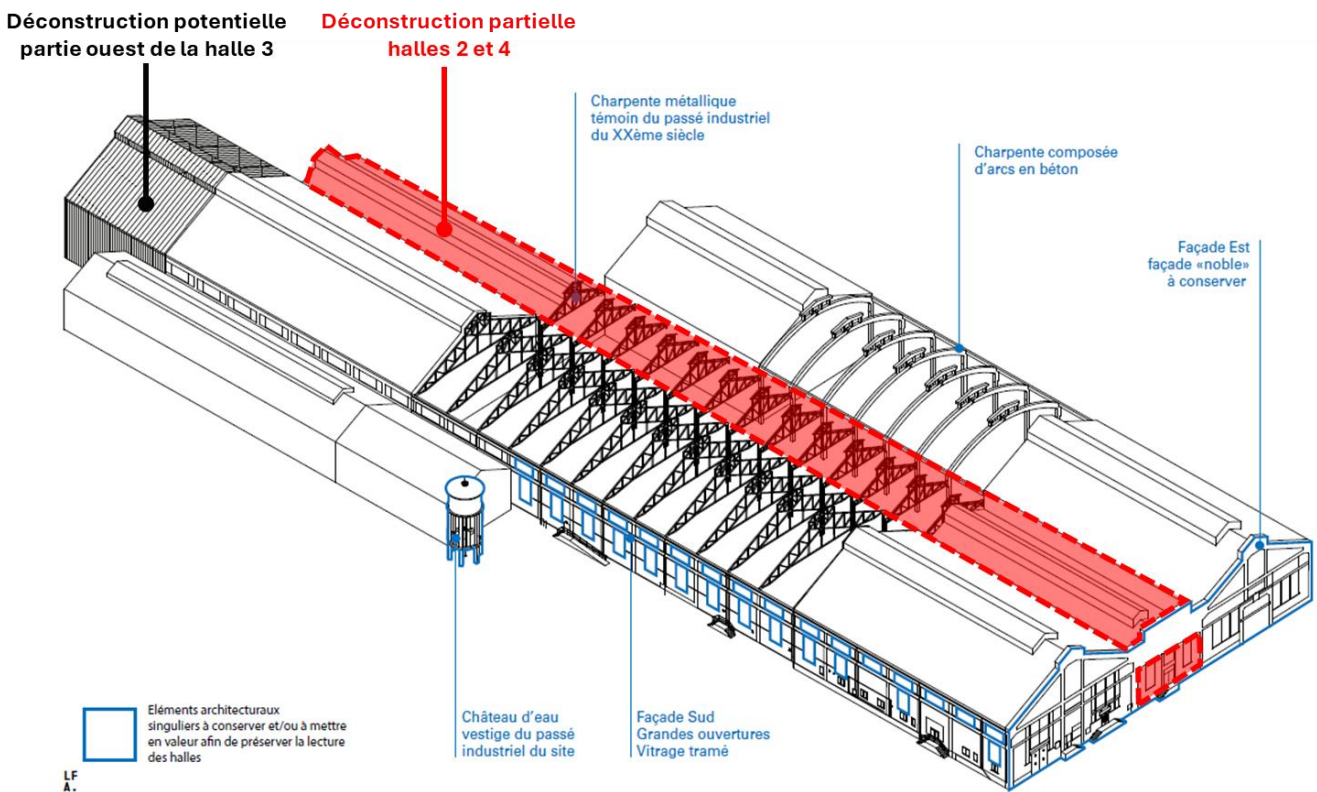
Orientations en matière de conservation du bâti et de déconstruction
